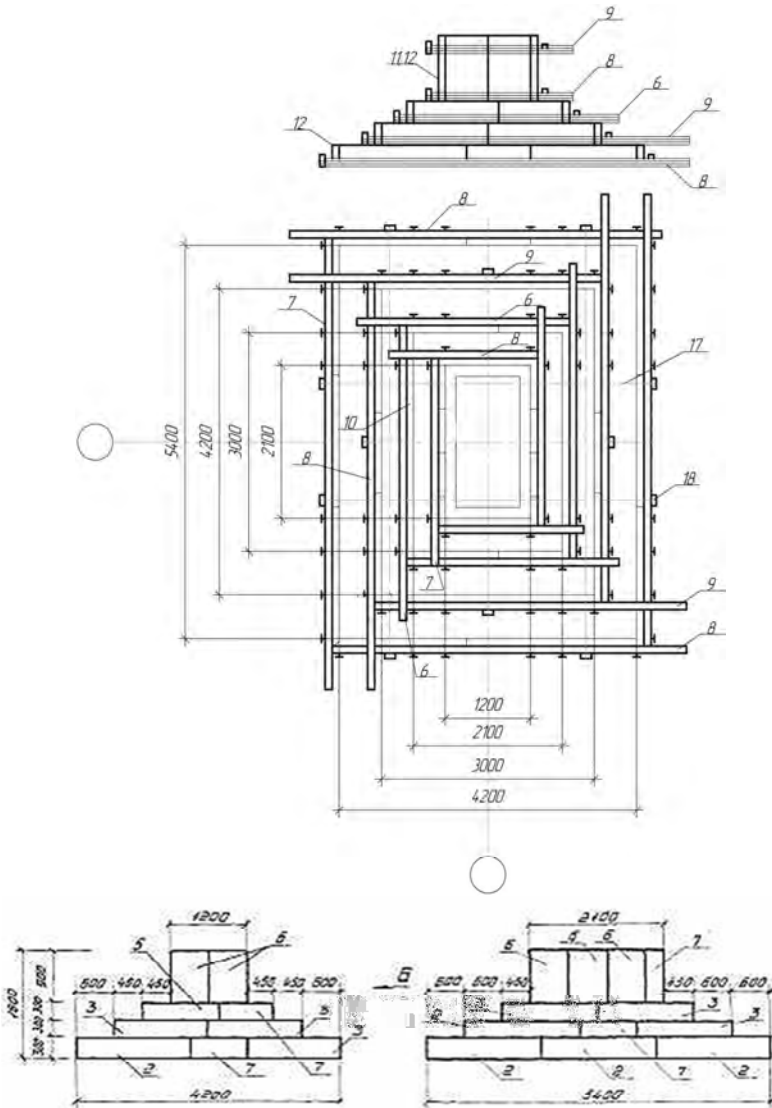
Пример конструирования мелкощитовой опалубки фундамента:
